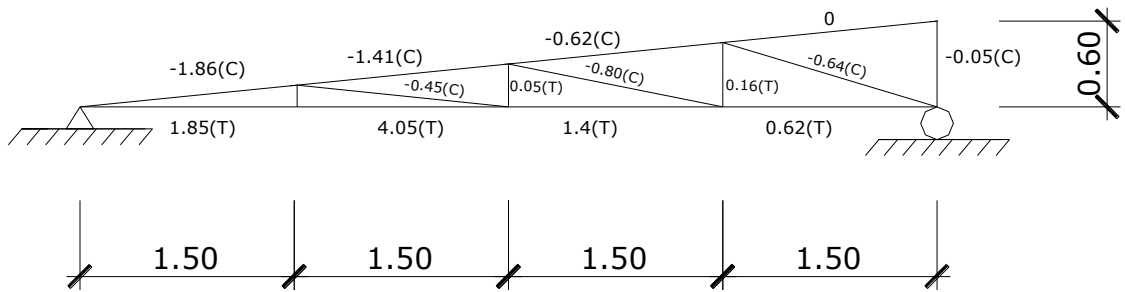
Reacciones internas de la carga viva de techo sobre la armadura.
